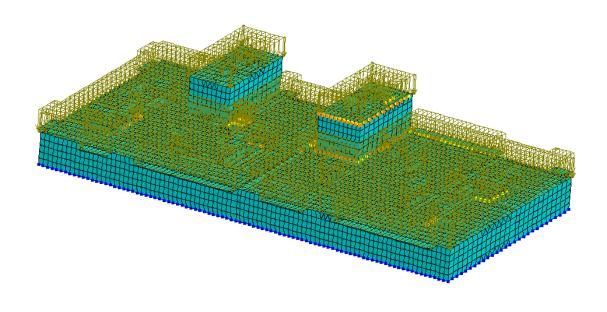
Расчетная схема плиты покрытия с нагрузкой от веса кровли
